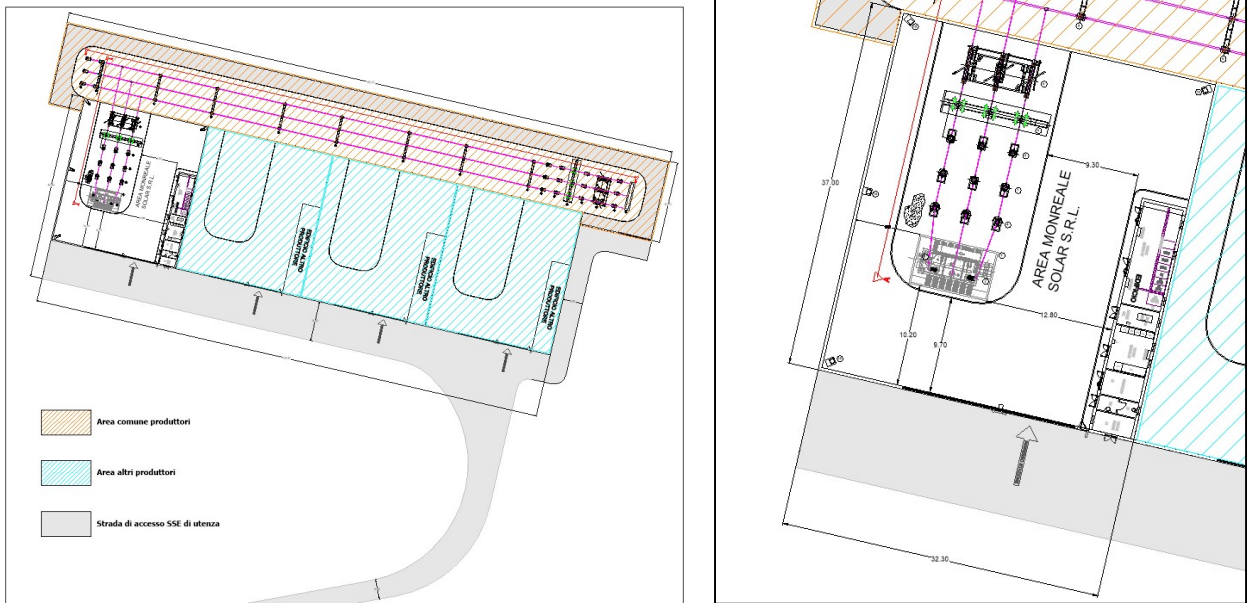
Planimetria elettromeccanica Sottostazione elettrica
